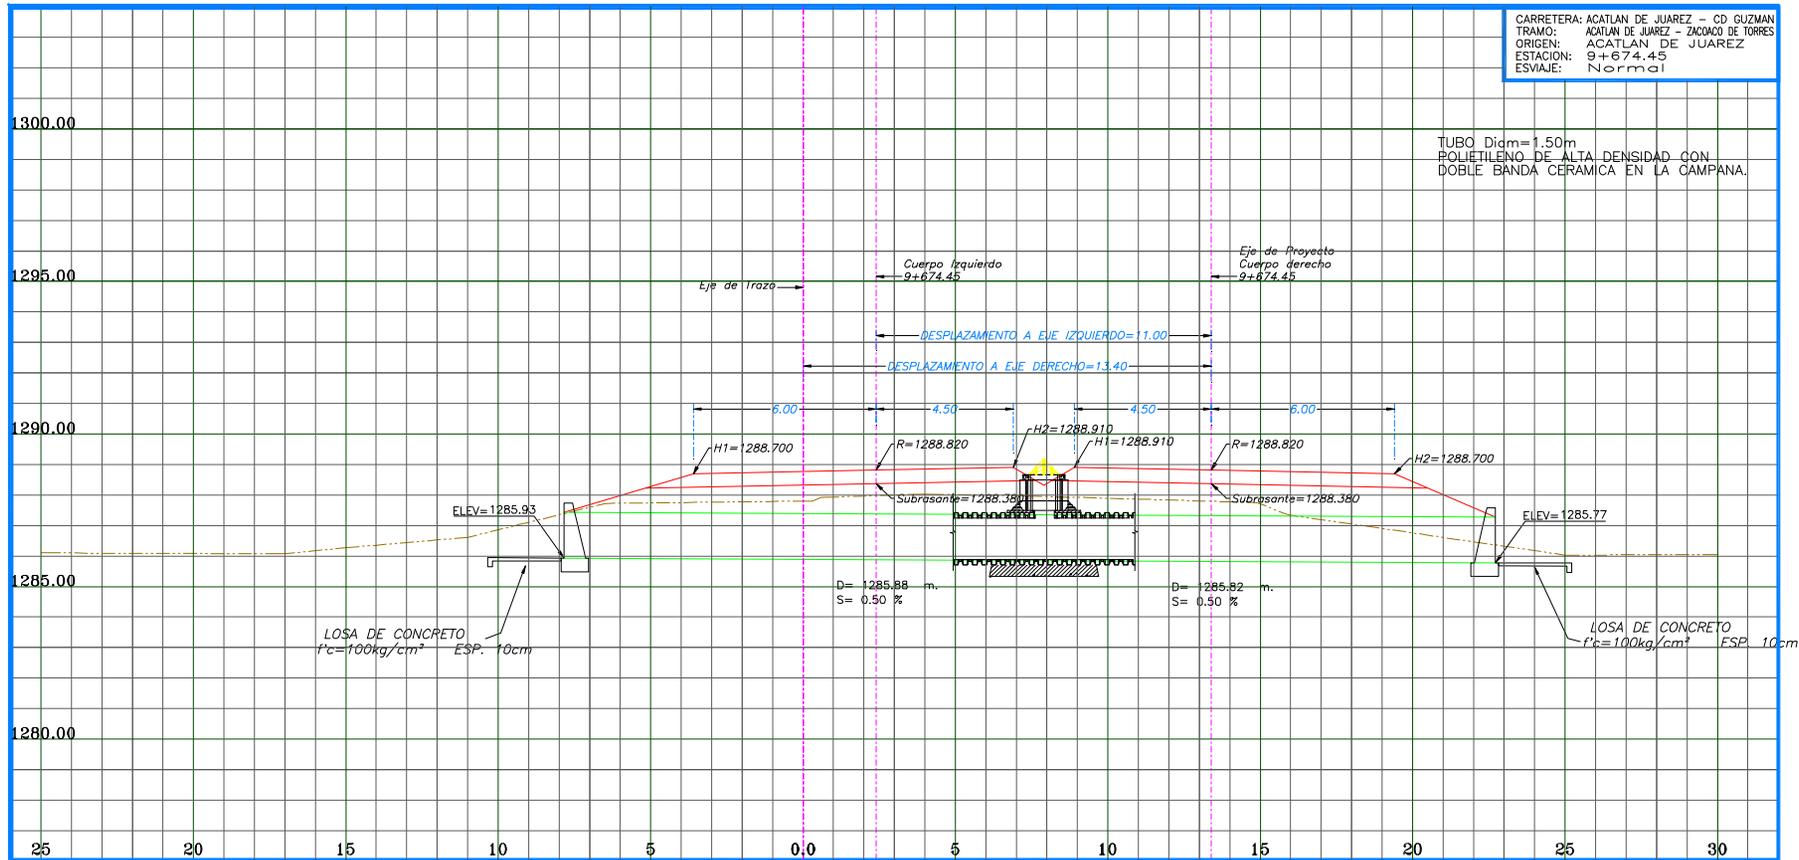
Perfil de Construcción de la obra de drenaje en el km 9+674.45
